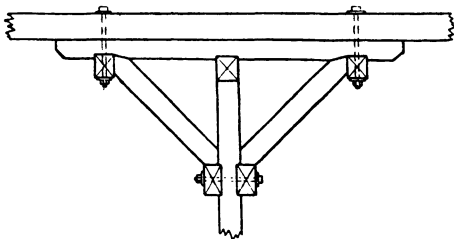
Auflagerung mittels Sattelholz u. Kopfstreben.
